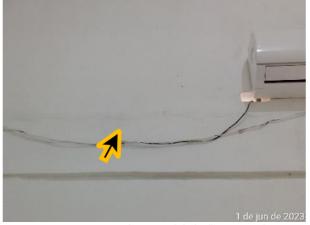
Vista em plano geral da lesão na parede – Coordenação – Jun/2023.
